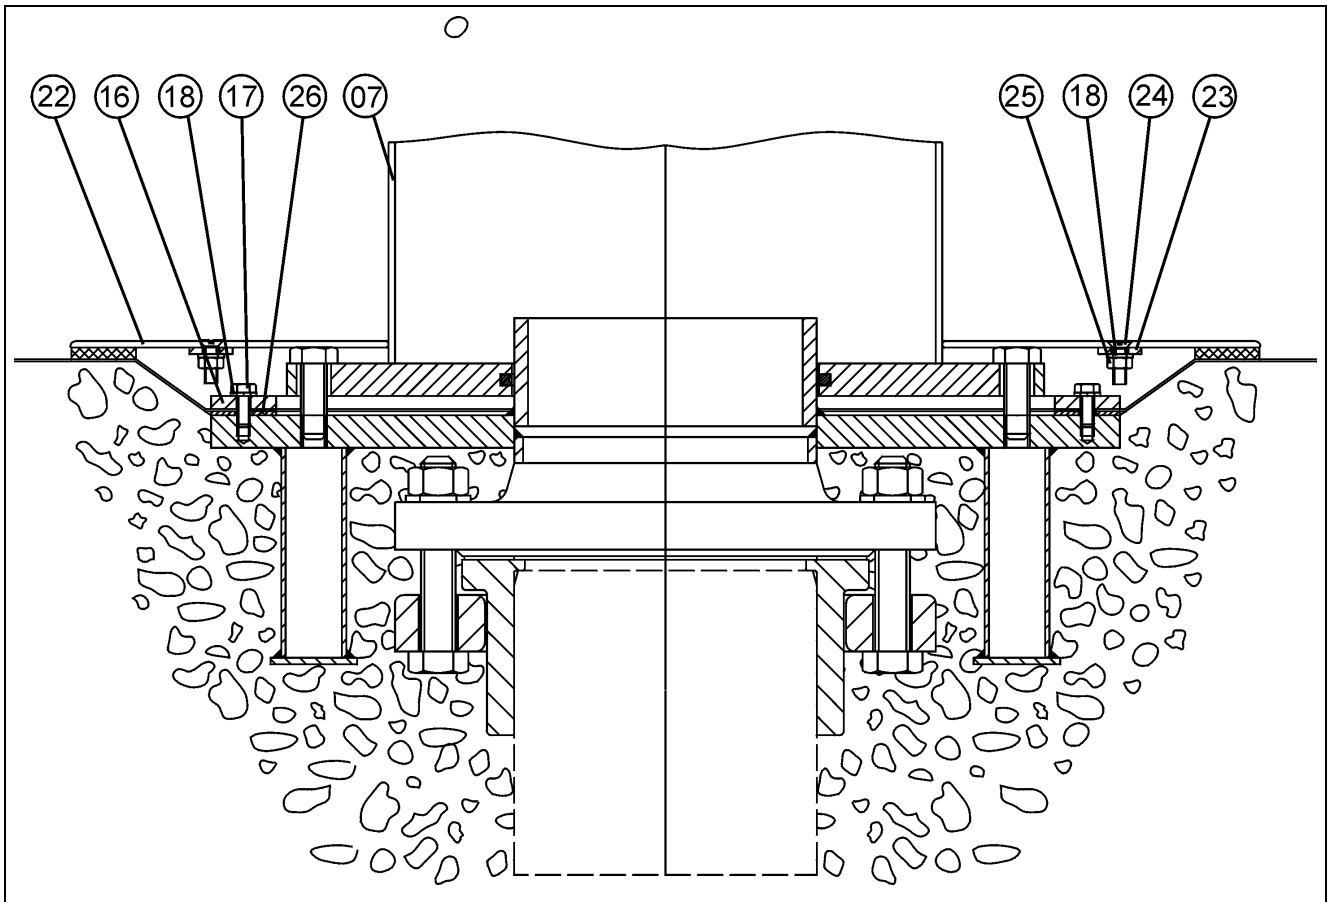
Bassin béton-liner / amenée d'eau verticale
